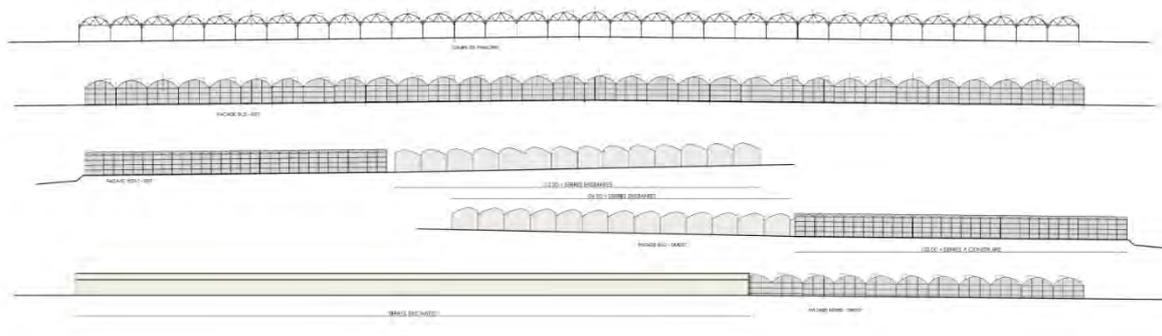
Vue des façades (Source : ARCHIJOLY)
